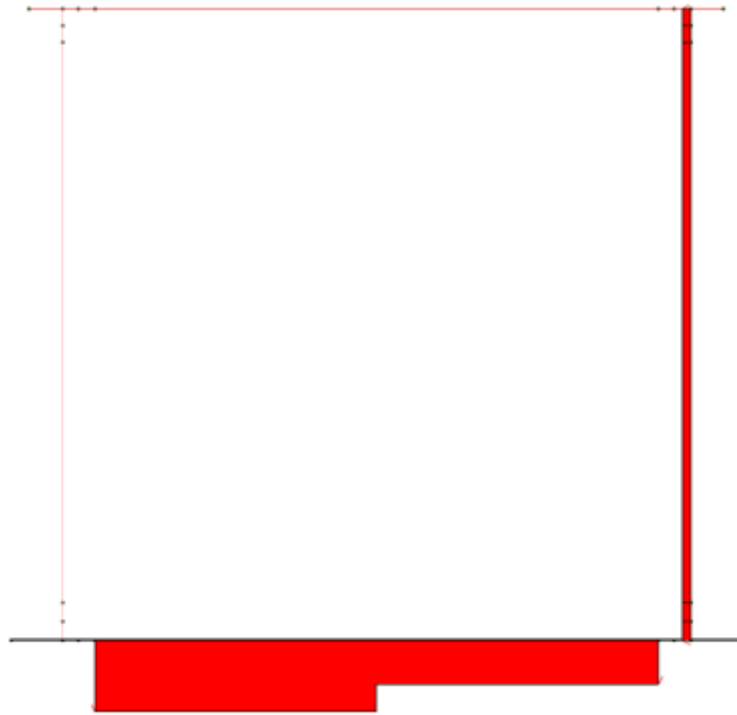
SPINTA DEL SOVRACCARICO 20 kN/M2 SUL PIEDRITTO DESTRO E SOVRACCARICO ACCIDENTALE SULLA SOLETTA DI FONDAZIONE (CDC 13)
